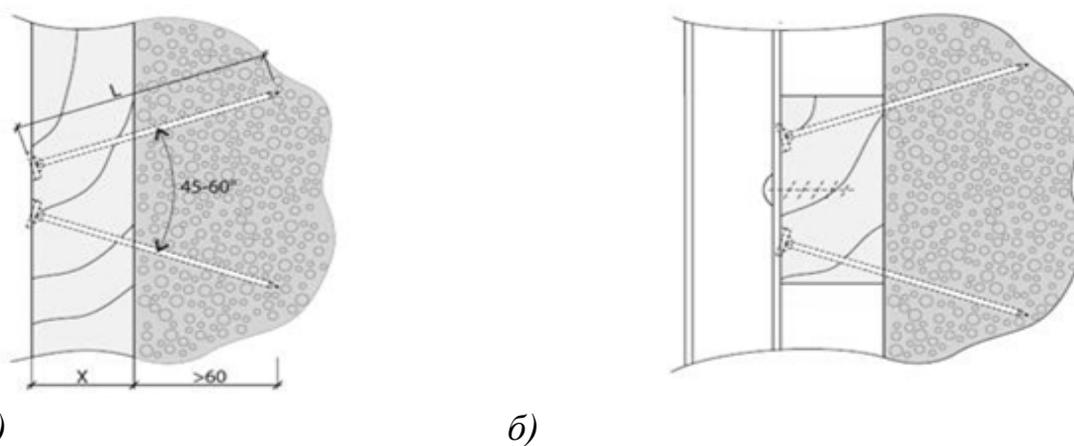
Гвоздевое крепление обрешетки: *а* — деревянный брусок, набитый на кладку непосредственно; *б* — крепление профиля через опорный брусок
